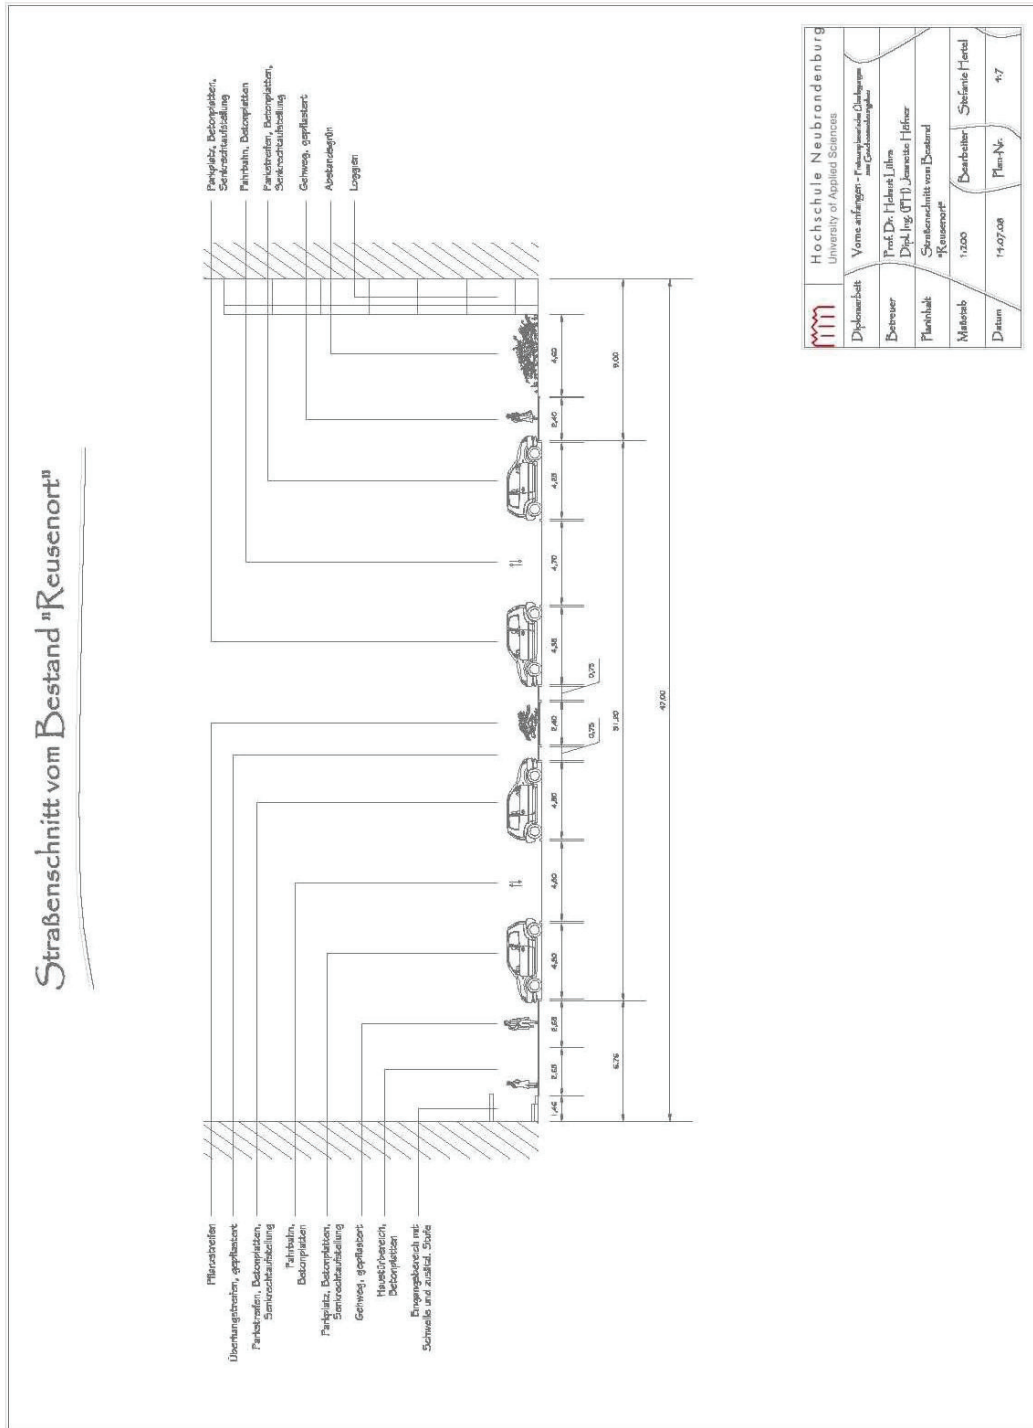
Straßenschnitt vom Bestand „Reusenort“
